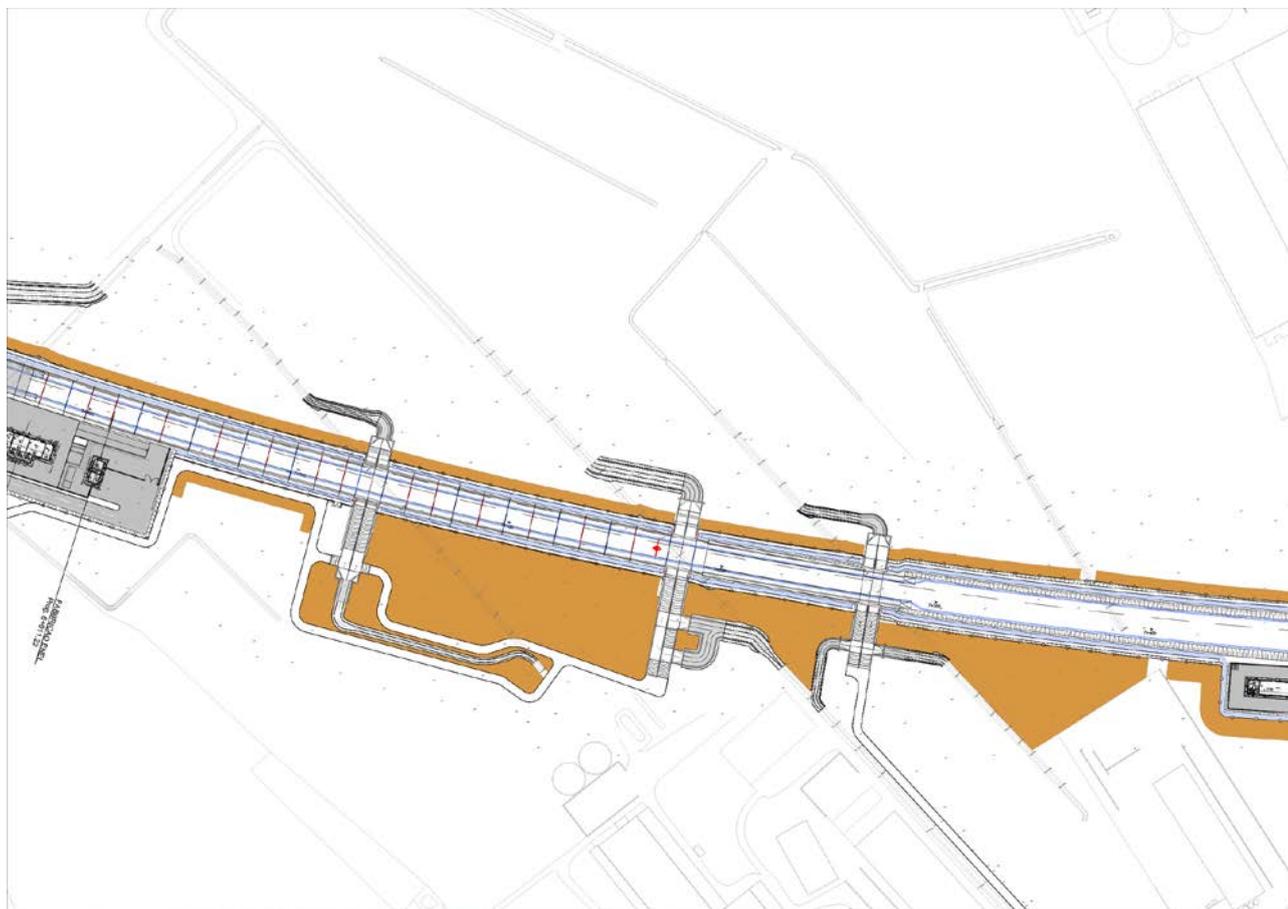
Stralcio Planimetria di PE con evidenziate le aree interessate dalle lavorazioni preliminari
